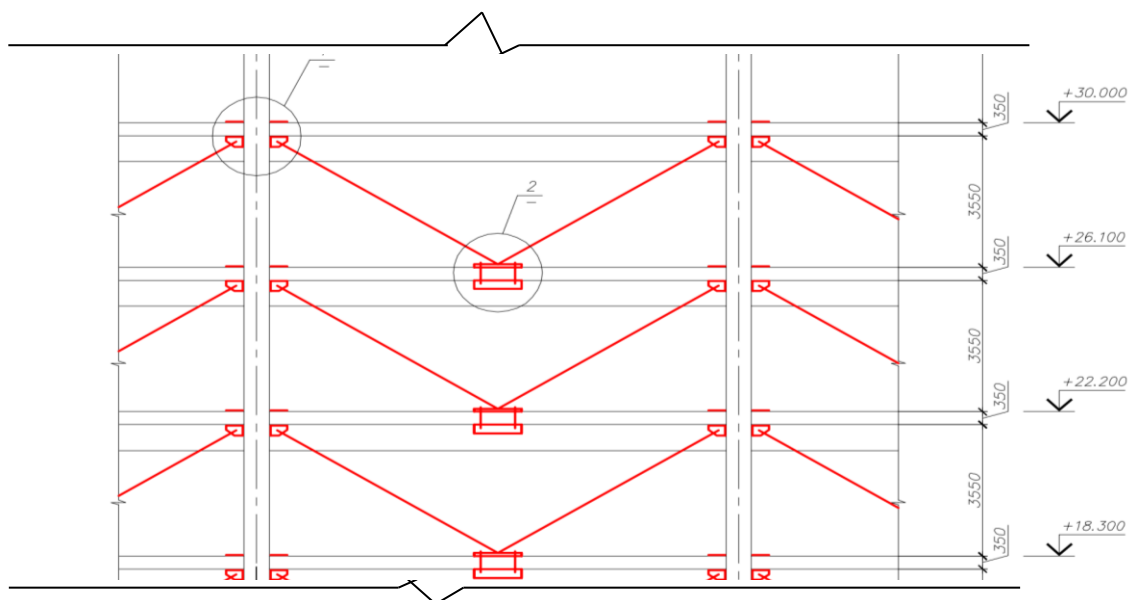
Фрагмент усиления кольцевых балок перекрытия по внешнему и внутреннему периметру фасада здания
